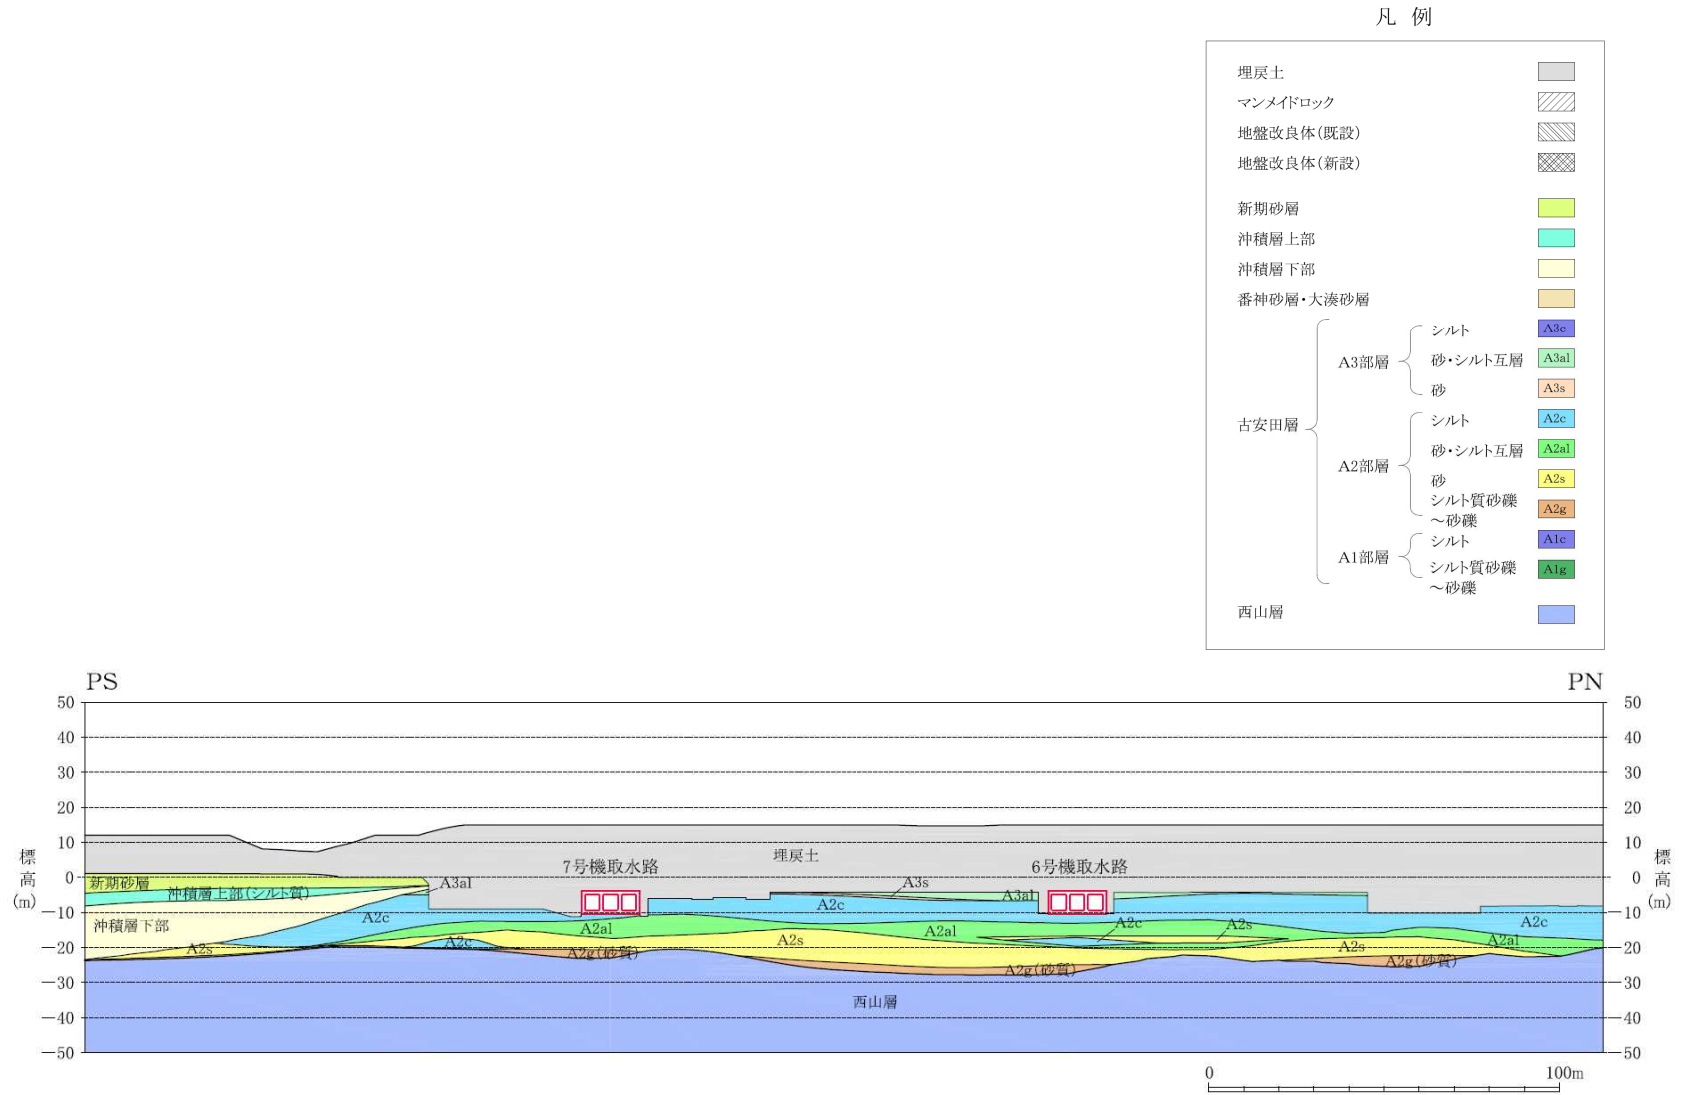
汀線平行 地質断面図 (6・7号機取水路一般部) (C-C断面)
